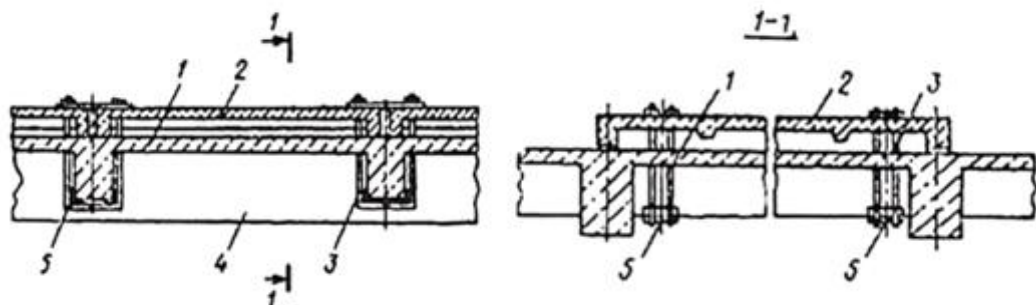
Разгрузка монолитной железобетонной плиты ребристой железобетонной плитой:
